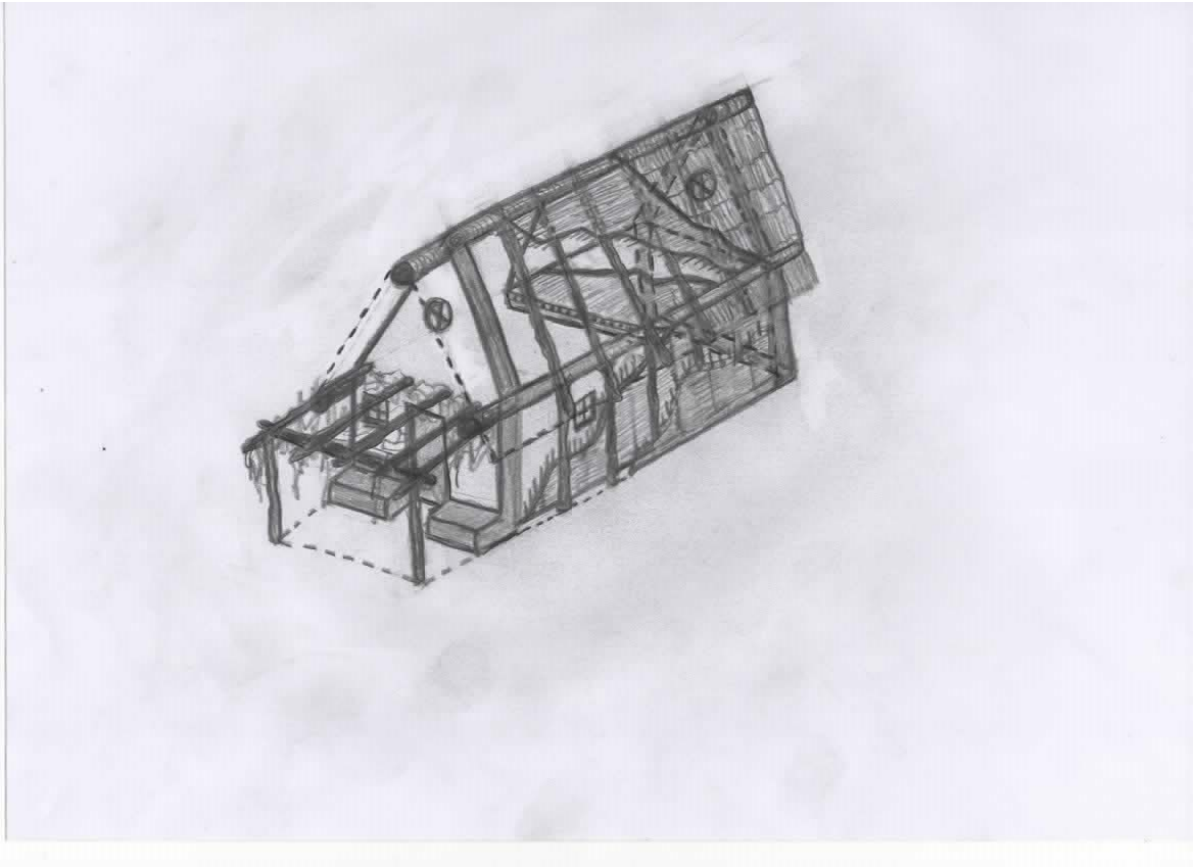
/12: Perspectiva de barraca murciana del tipo mixto (fachadas norte y sur de atobas aparejadas y fachadas este / oeste - testeros construidos con troncos normalmente de morera y doble cañizo interior y exterior revestidos con barro o yeso).
